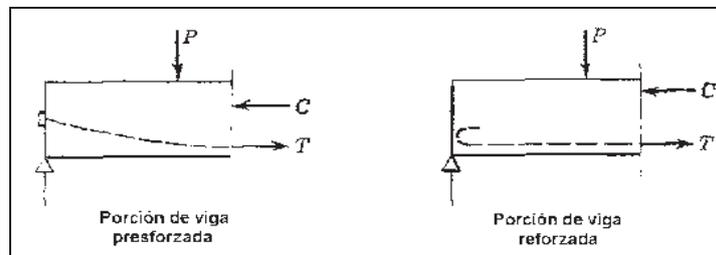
Momento interno resistente en vigas de concreto presforzadas y reforzadas [2].
